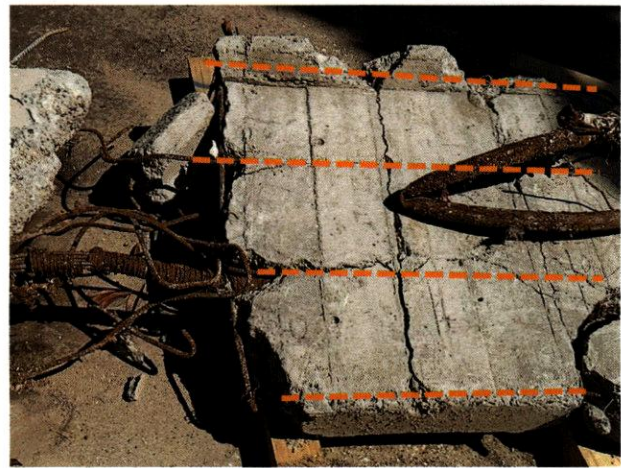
Cuatro filas de refuerzo longitudinal en el espécimen de viga F-C-BM-9. Las líneas discontinuas en color naranja ilustran el refuerzo.
